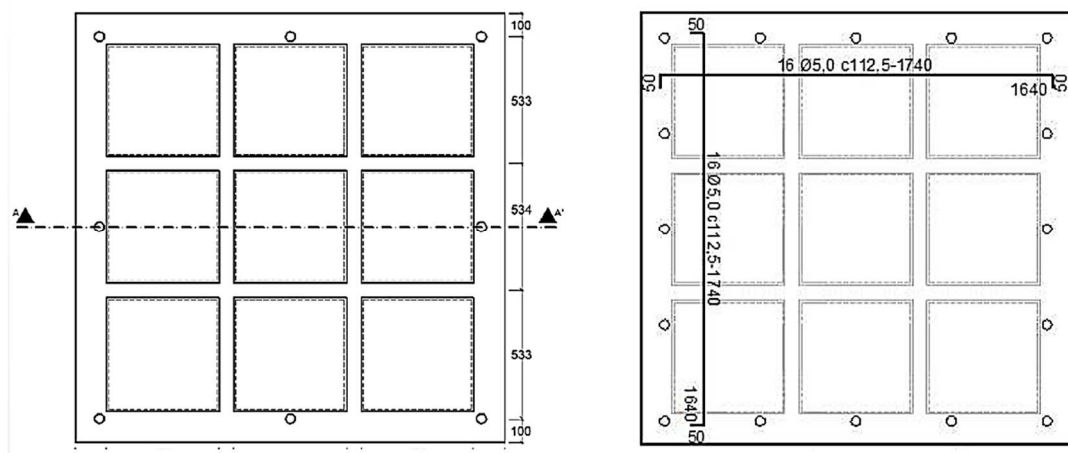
(a) Dimensões da laje REF em mm (b) Detalhamento das armaduras da placa
